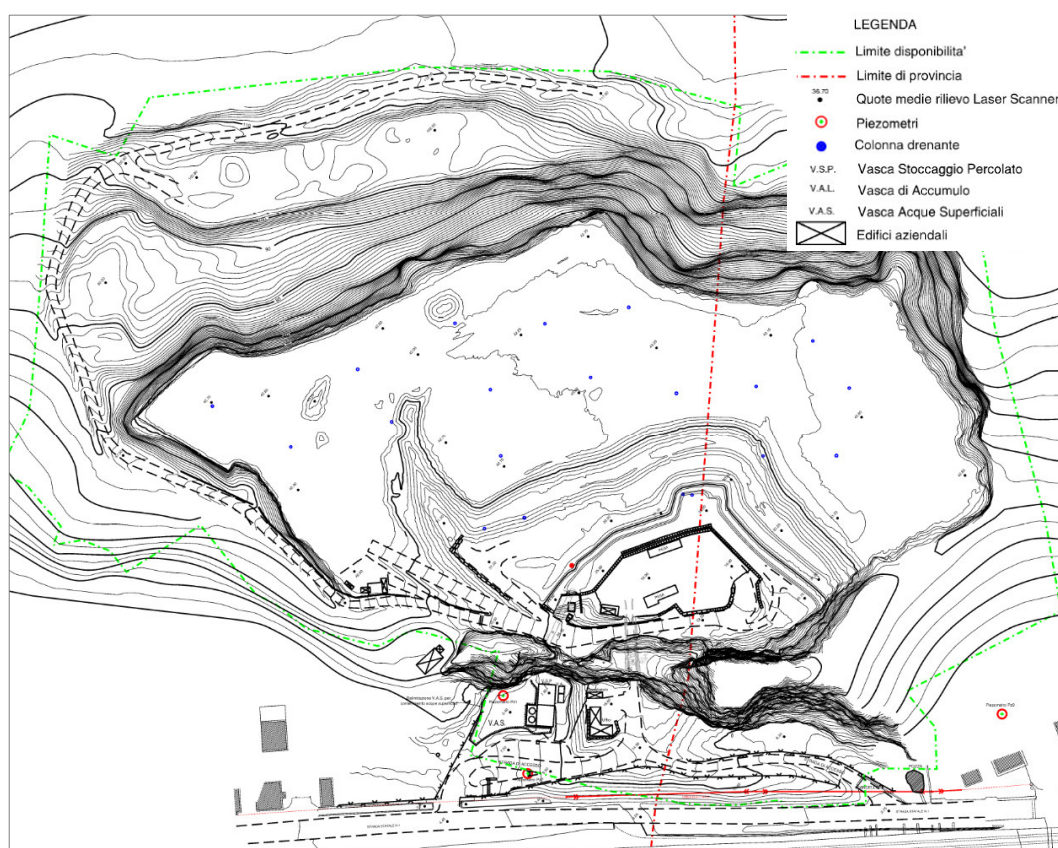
Estratto planimetria dello stato attuale dei luoghi (termine Fase 1)
